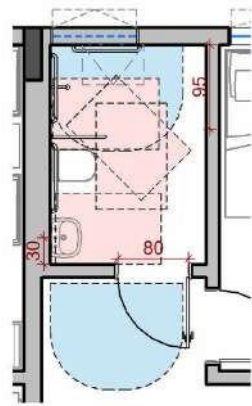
Detalhe do Banheiro Adaptável TA (98,75m<sup>2</sup>) - Detalhe 02
